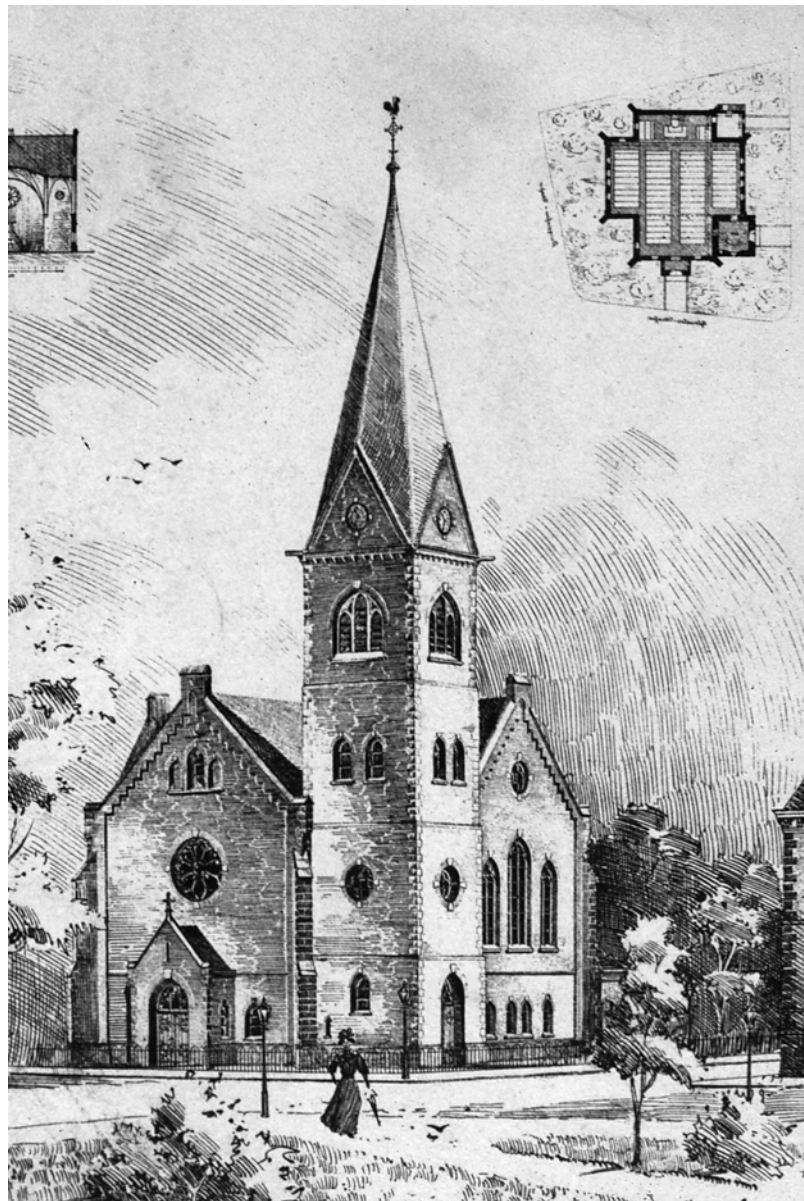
Entwurf Außenansicht und Grundriss
